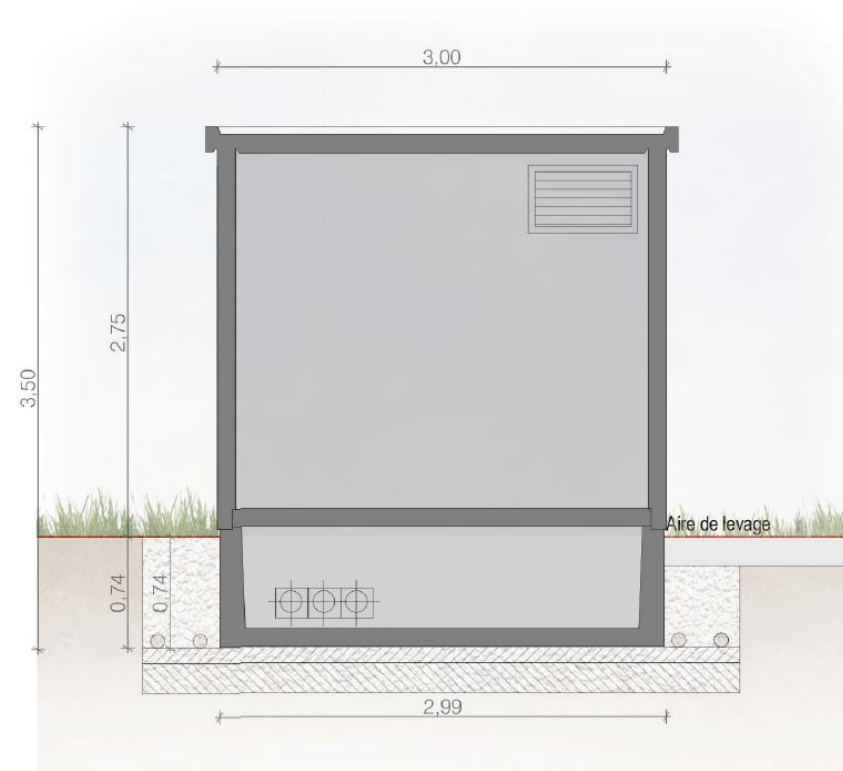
Coupe type d'un poste de livraison (exemple) - vue de profil
